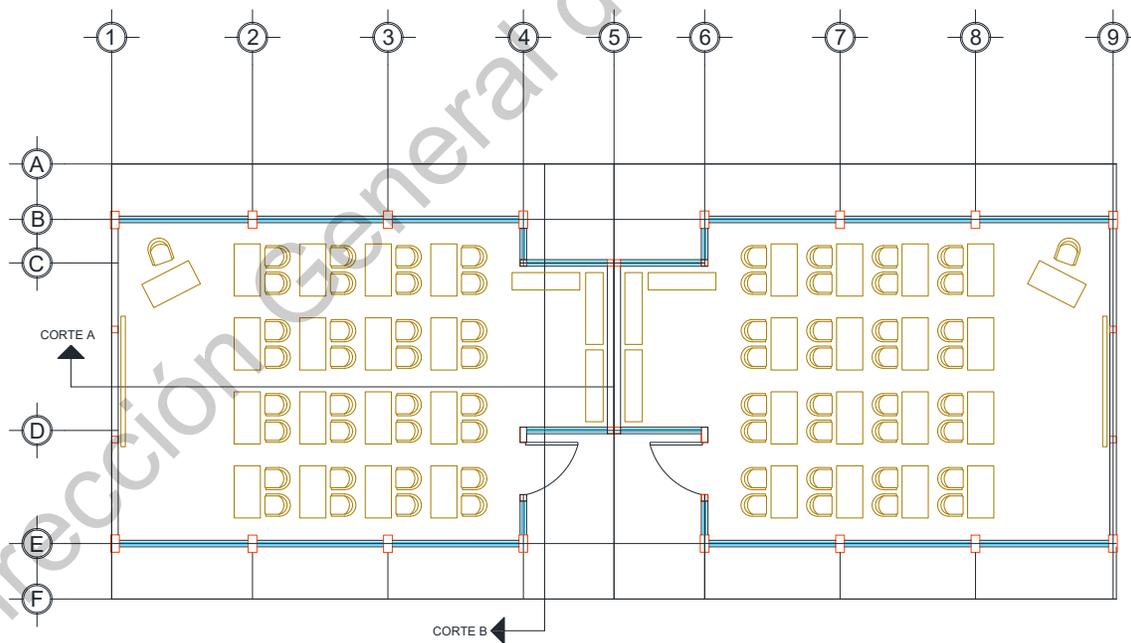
Planta Arquitectónica Zona C (Elaboración Propia)
